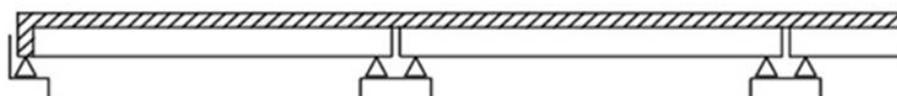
Dalle continue sur poutres simplement appuyées d'un pont à poutres
